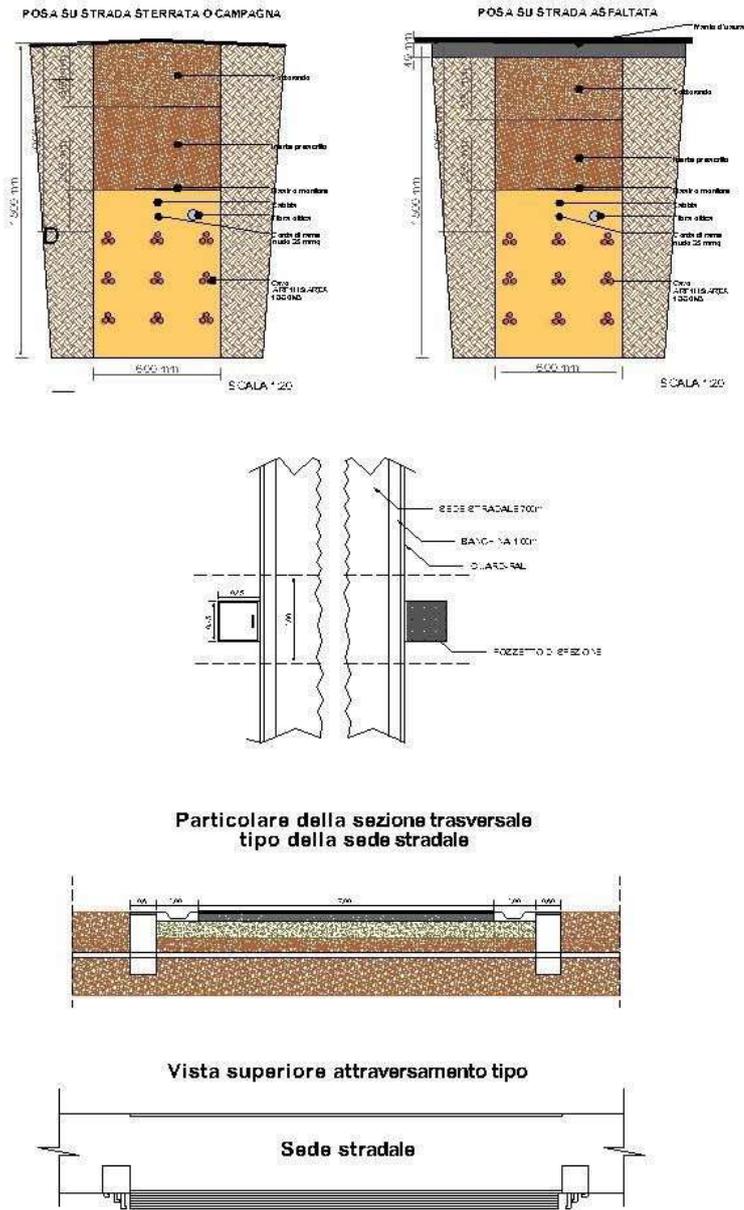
Particolare sezione tipo cavo interrato MT e particolari della sezione stradale
